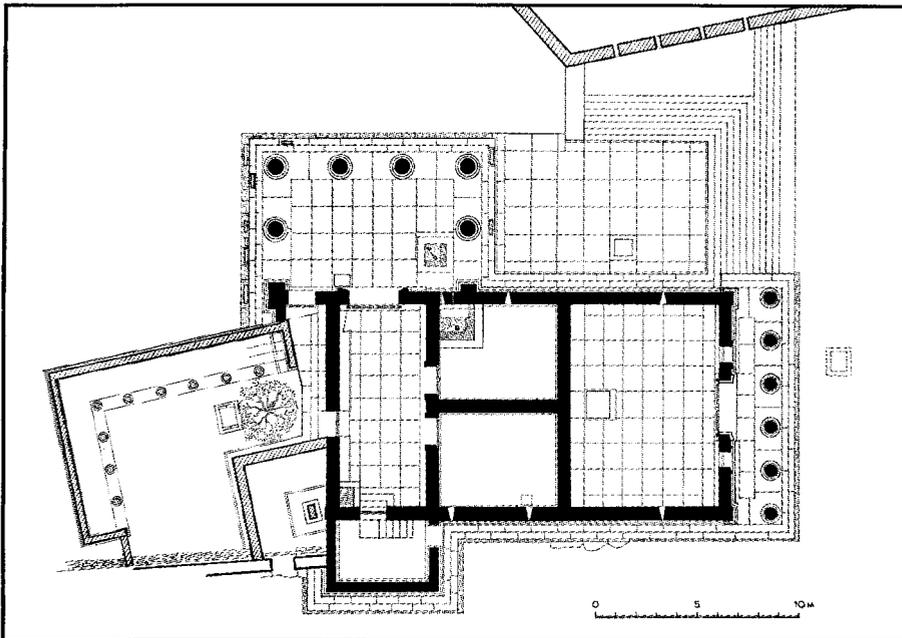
Erechtheion, rekonstruierter Grundriss (Papanikolaou)
